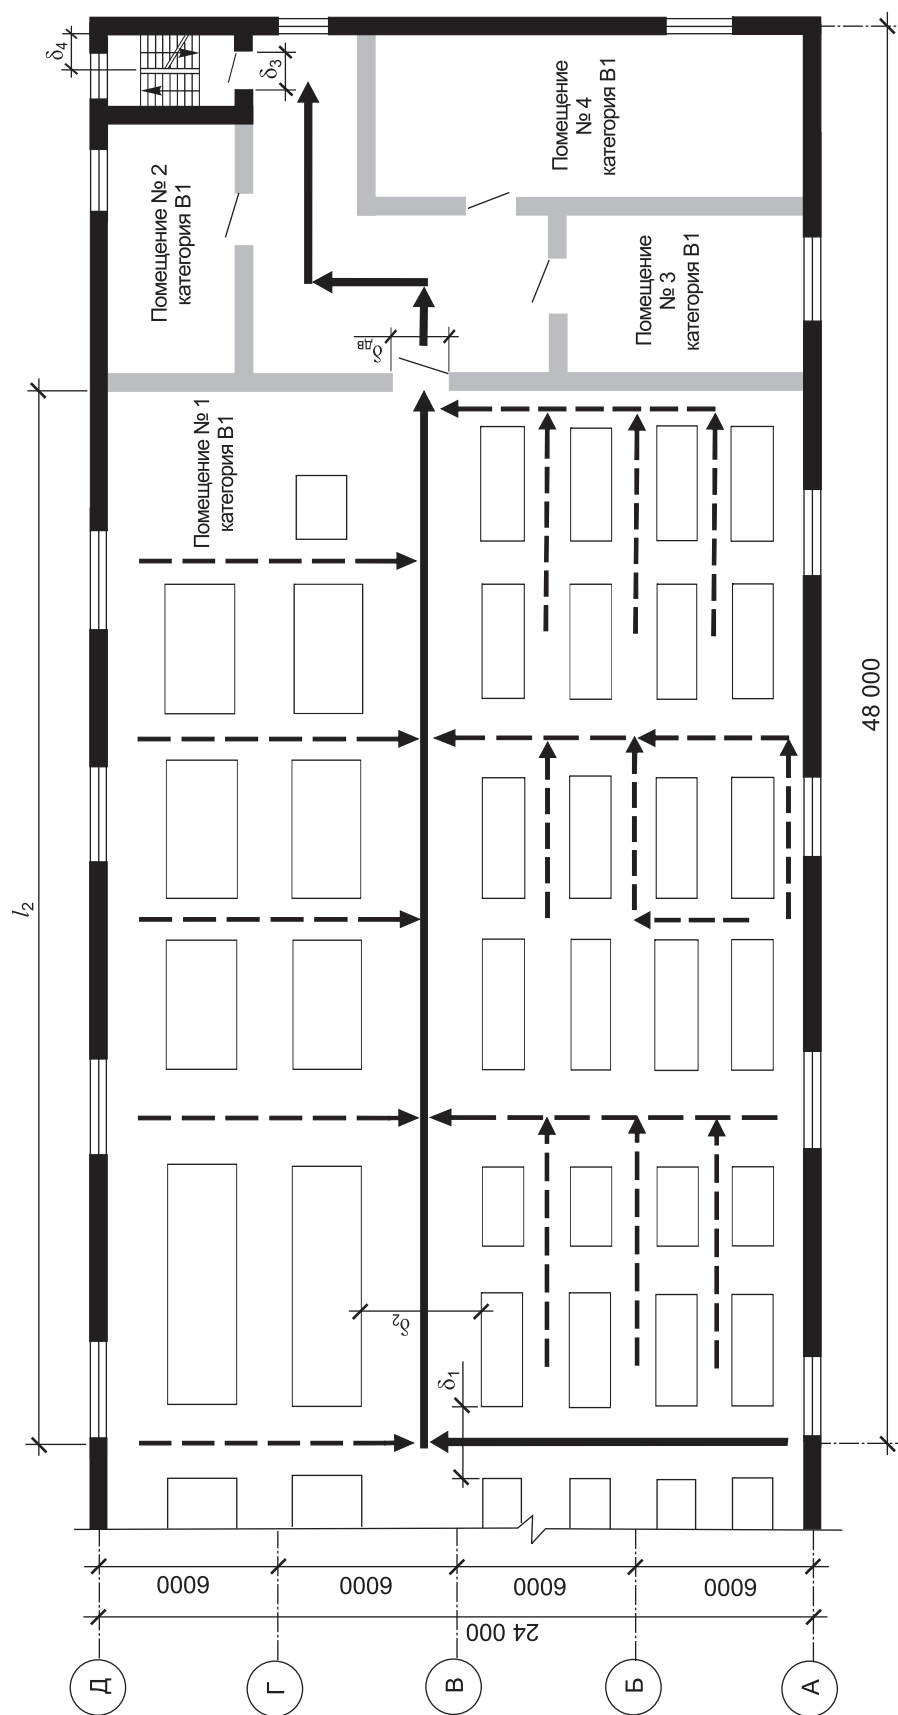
Фрагмент схемы четвертого этажа производственного здания с расчетной схемой эвакуации
